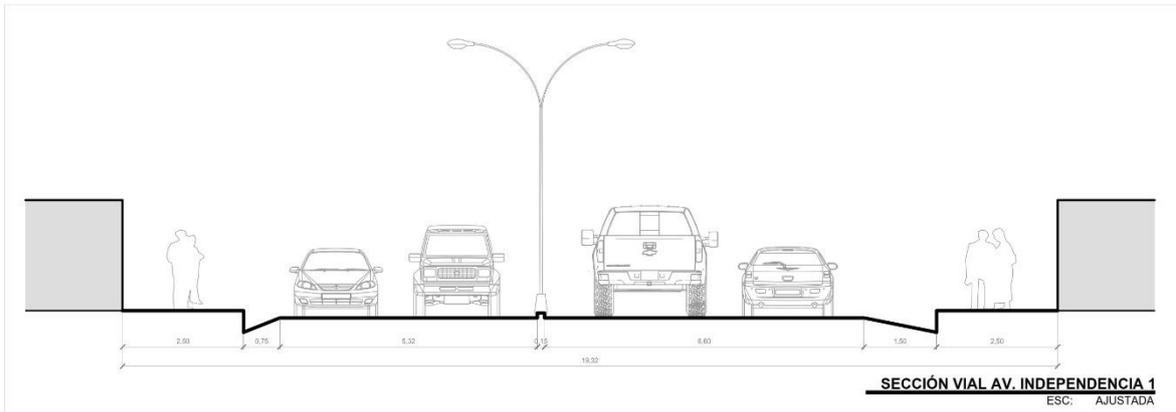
Sección Vial 7 – Avenida Independencia Primera Cuadra.
